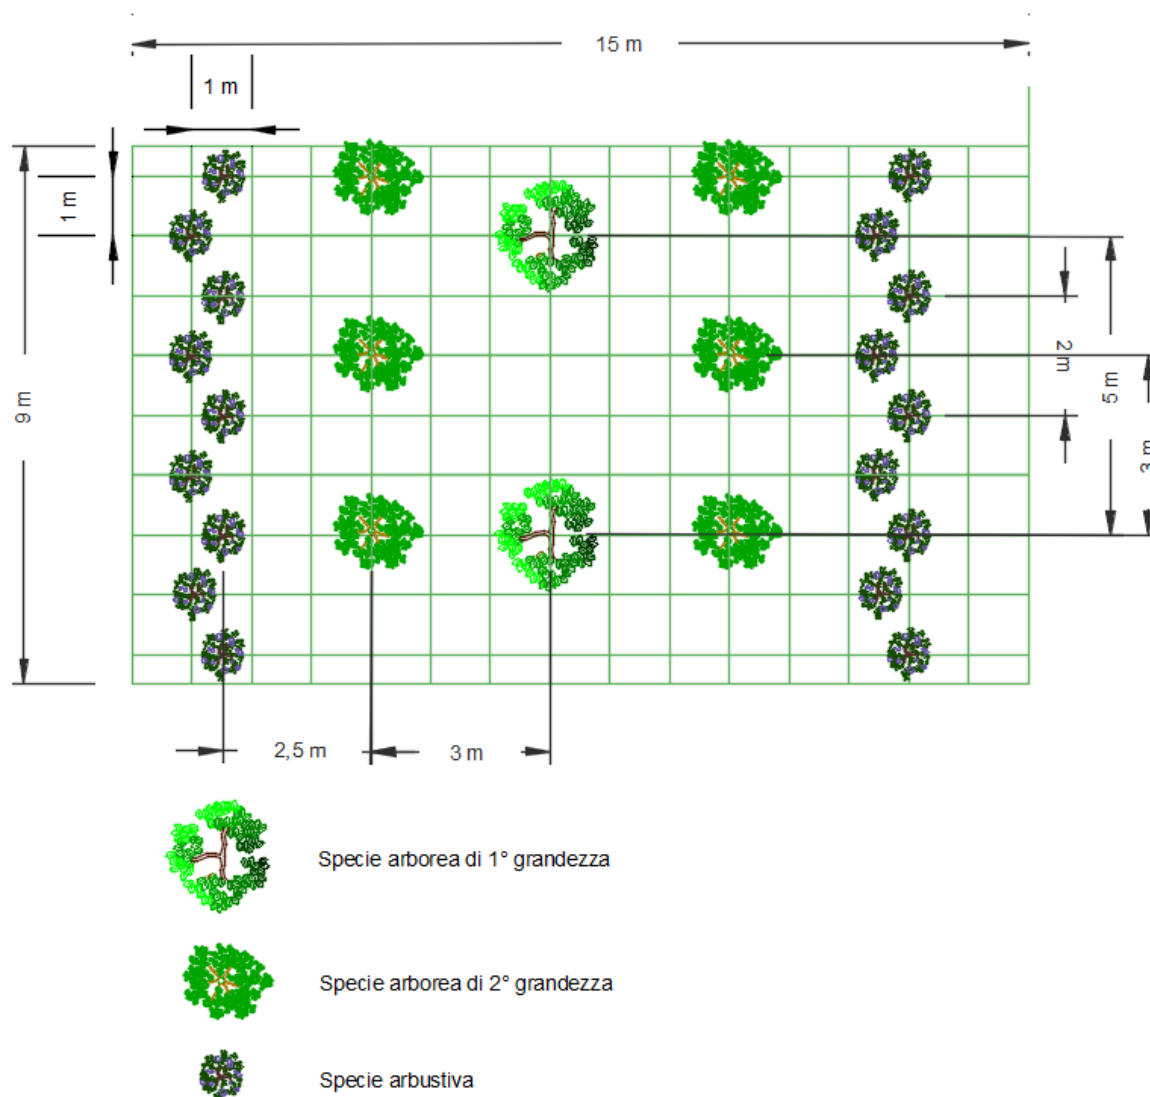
Modulo e sesto d'impianto della fascia schermante con struttura "a tetto"
